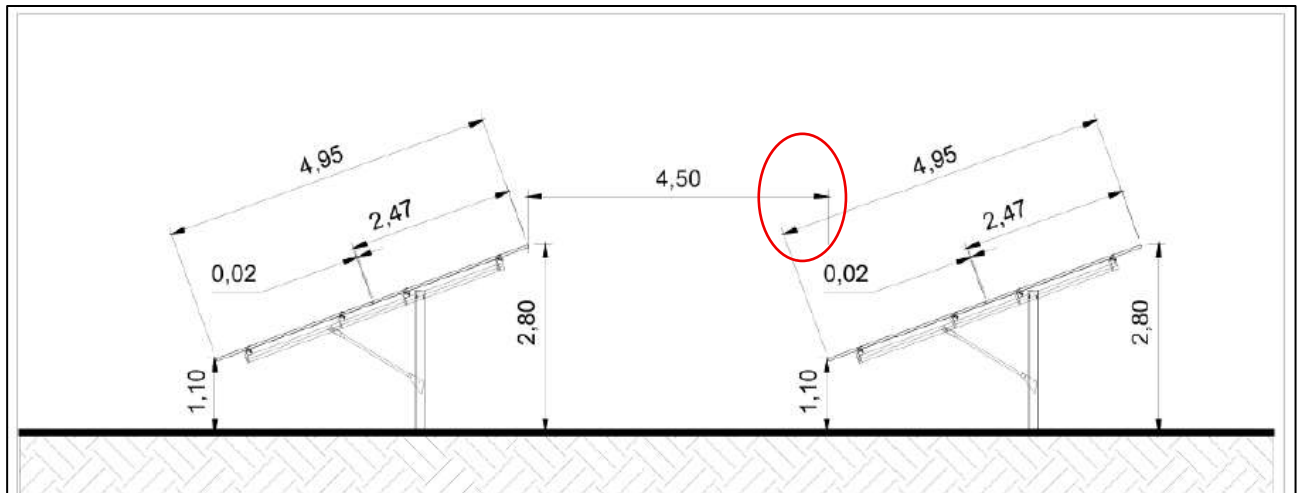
plan des panneaux photovoltaïques projet (source : présentation REDEN en CM du 30/06/2026)
